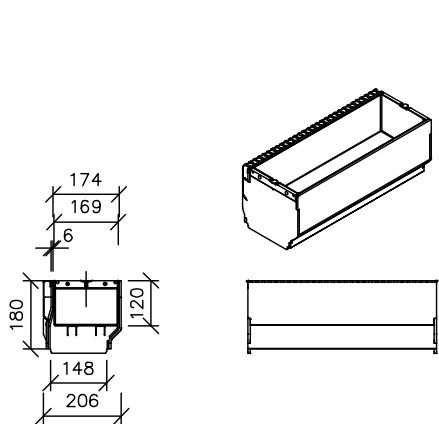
DETAIL BOČNÍ ŠTĚRBINY TSH 1500/160
